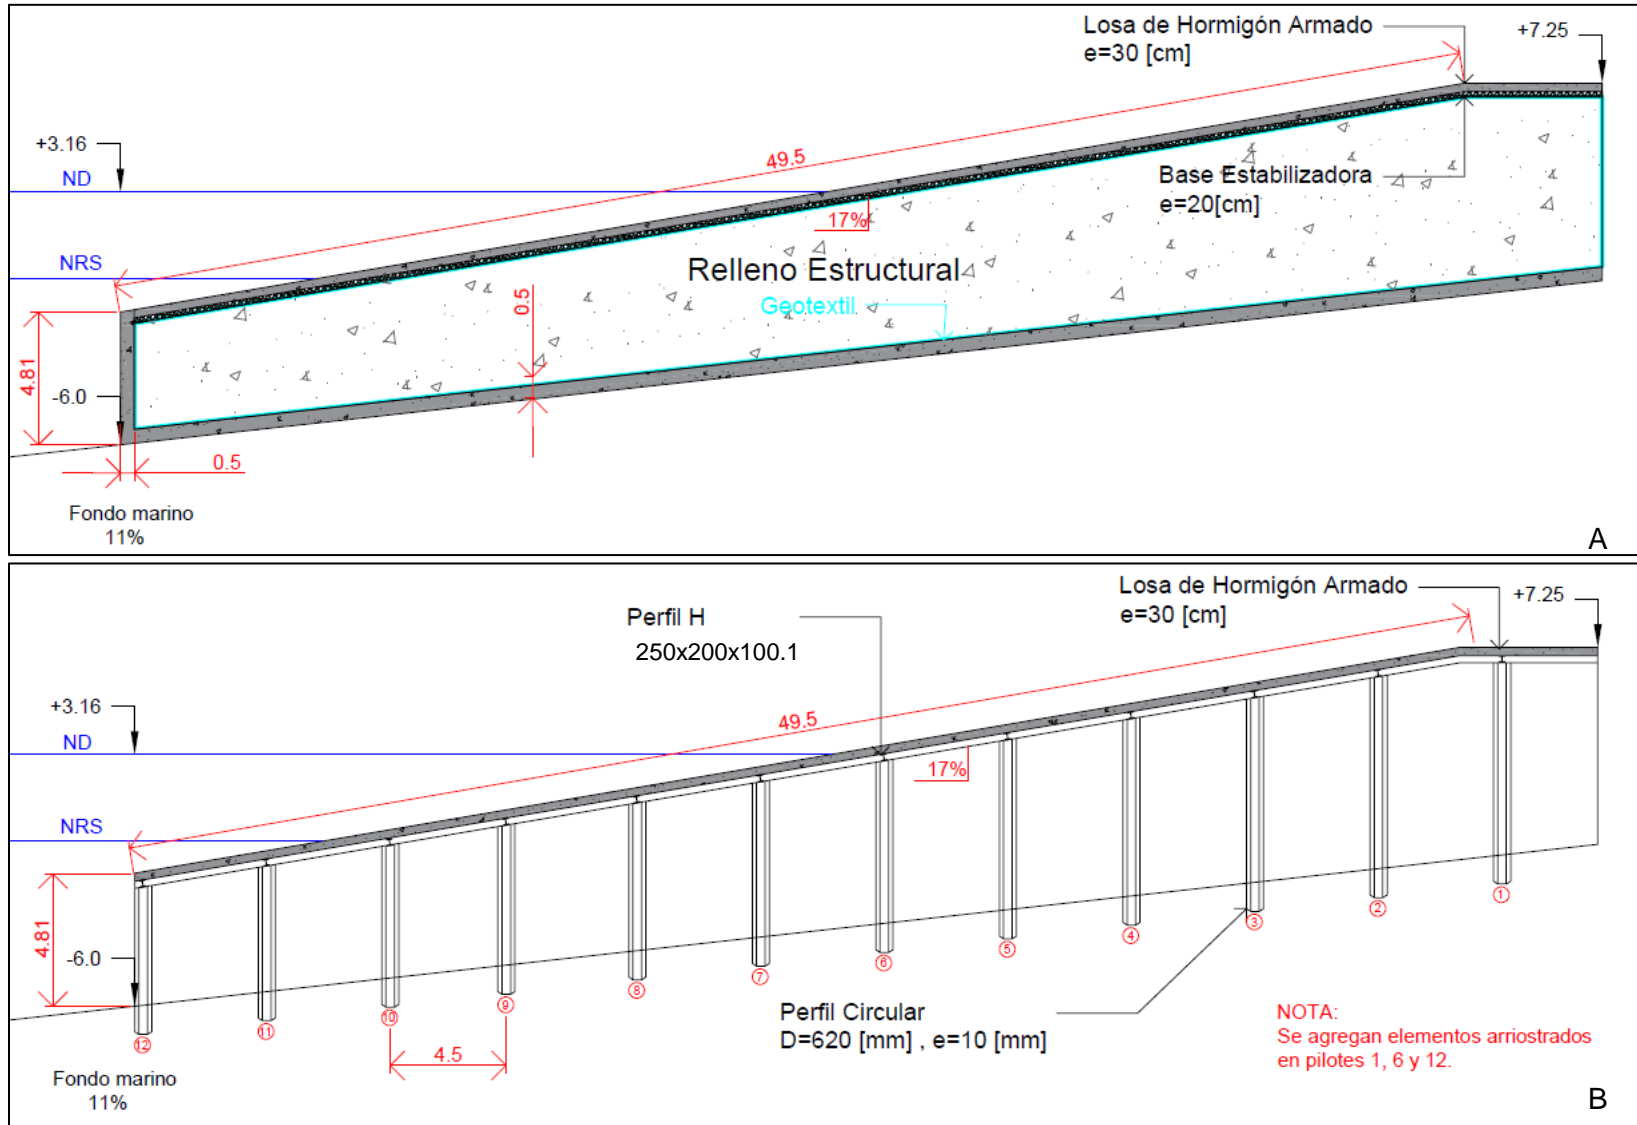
Plano perfil rampa A) Opaca y B) Transparente. Fuente: Elaboración propia con Autocad.
